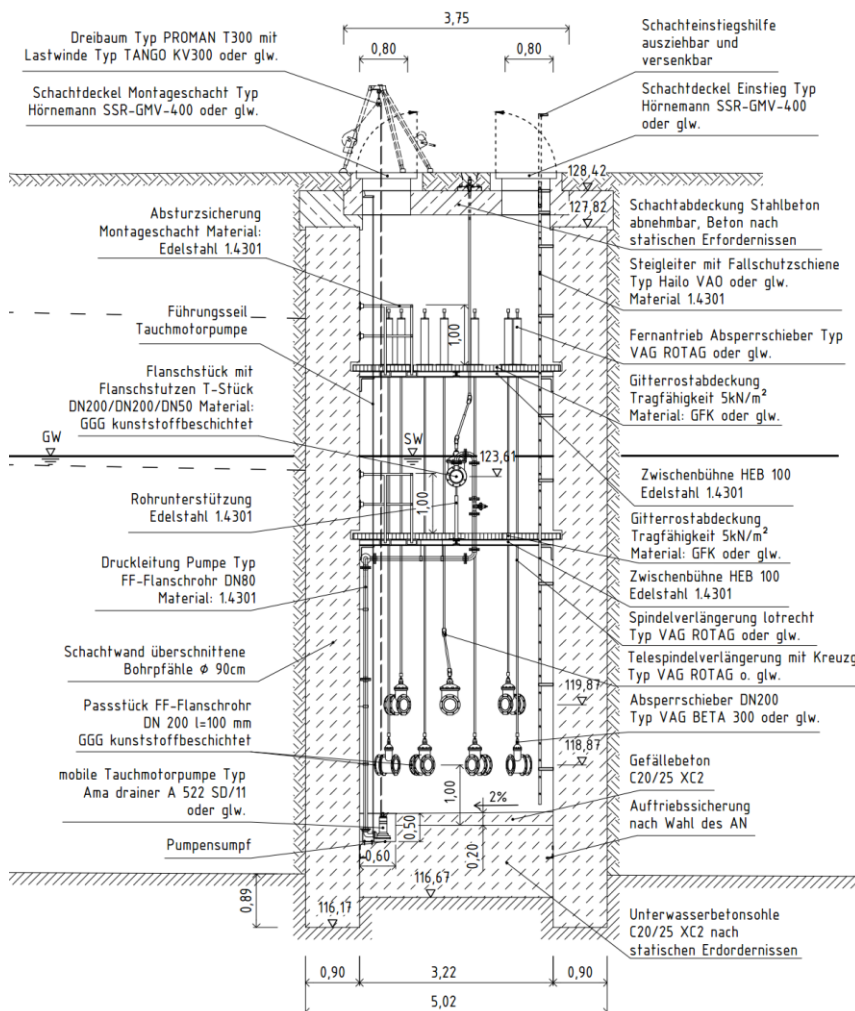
Schnittdarstellung mit Wartungsausrüstung
